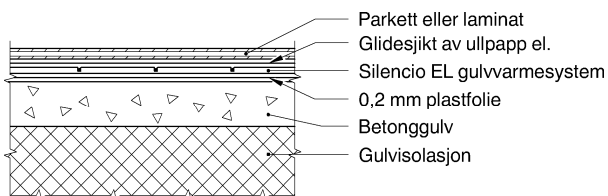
Silencio EL plater lagt direkte på avrettet, isolert betonggulv (f.eks. gulv på grunnen).
